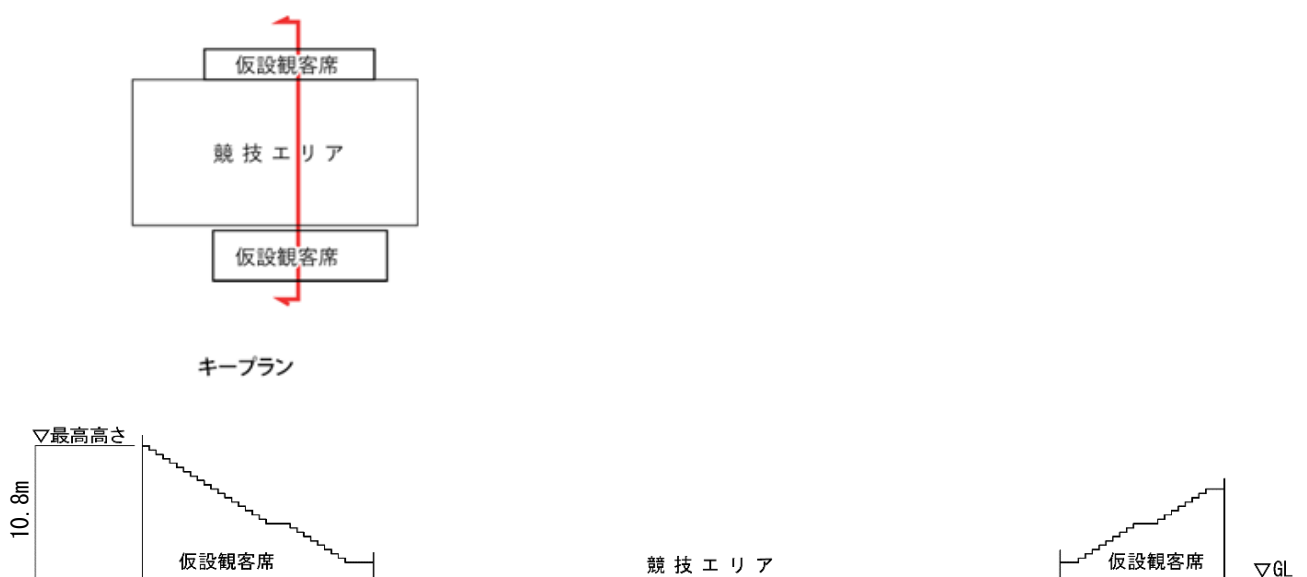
(2) 断面図 (自転車競技 (BMX レーシング))
